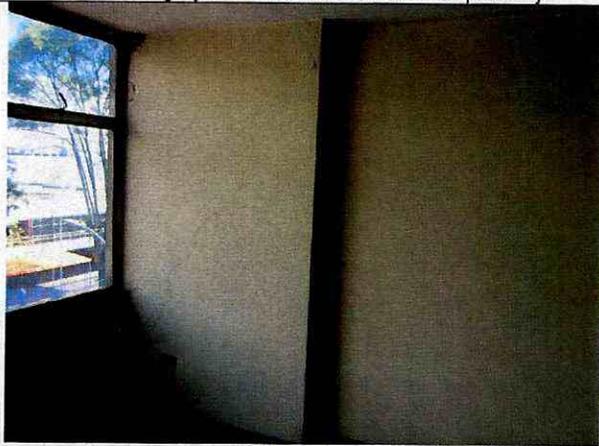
Grieta por separación de la junta entre elementos.
